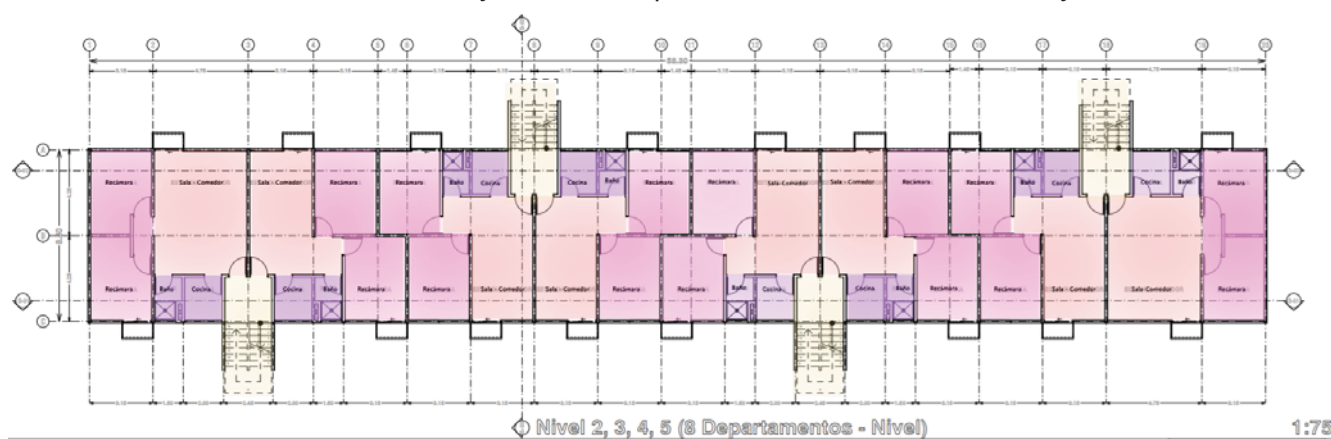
Planta tipo de los edificios 4A, 4B y 4C
